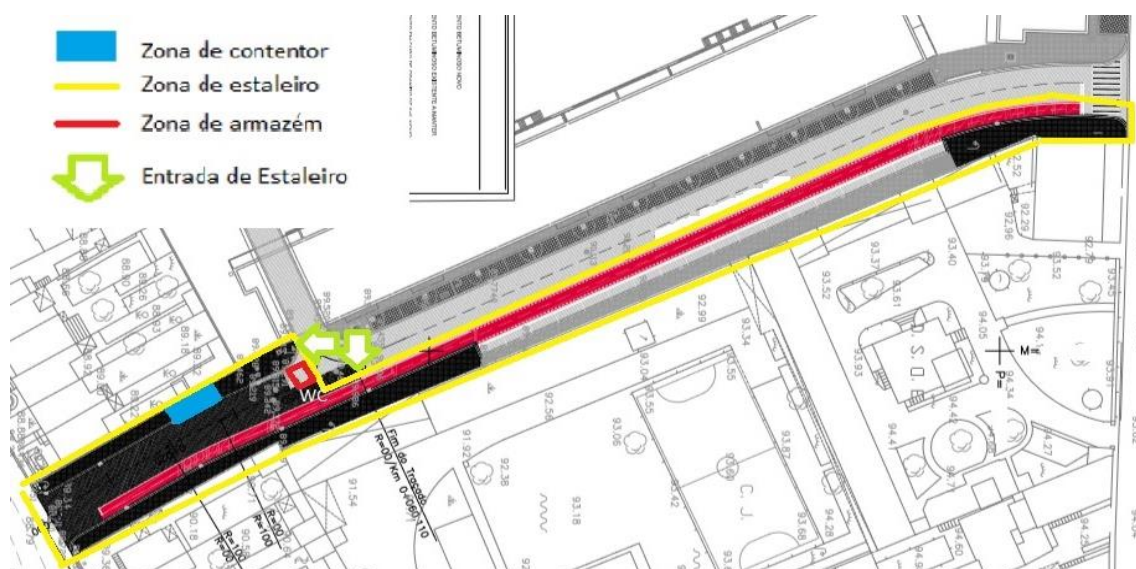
Esquema 3 com zona estaleiro e escritório adaptado da planta original cedida por [19]
